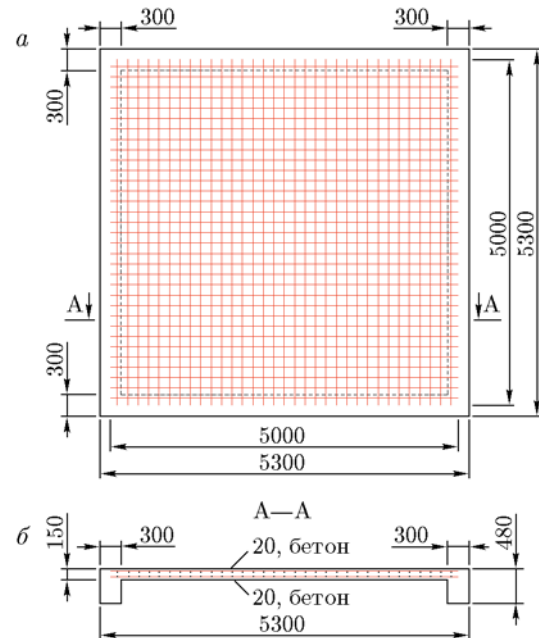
Железобетонная плита (а) и ее поперечное сечение (б):
